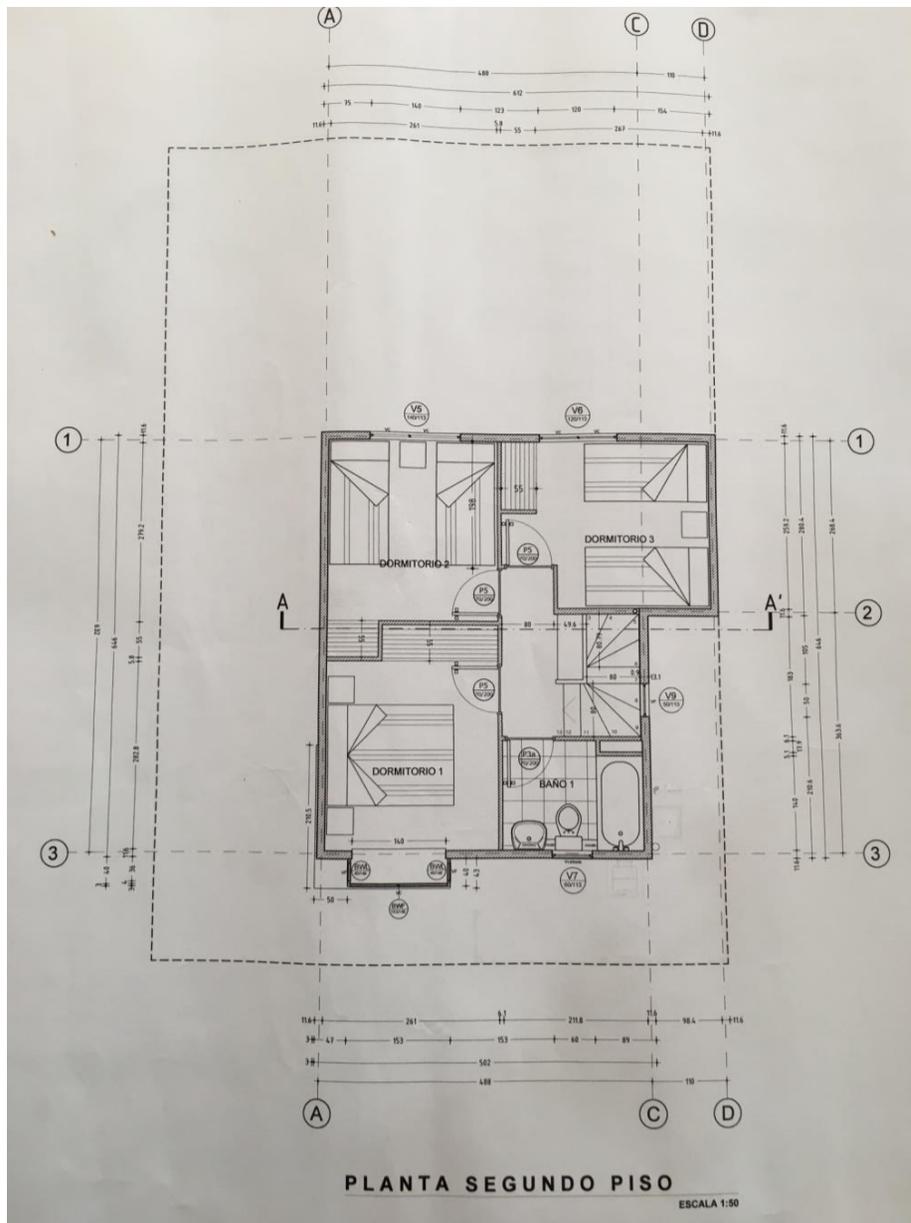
Planta segundo piso casa tipo B1 aislada.
